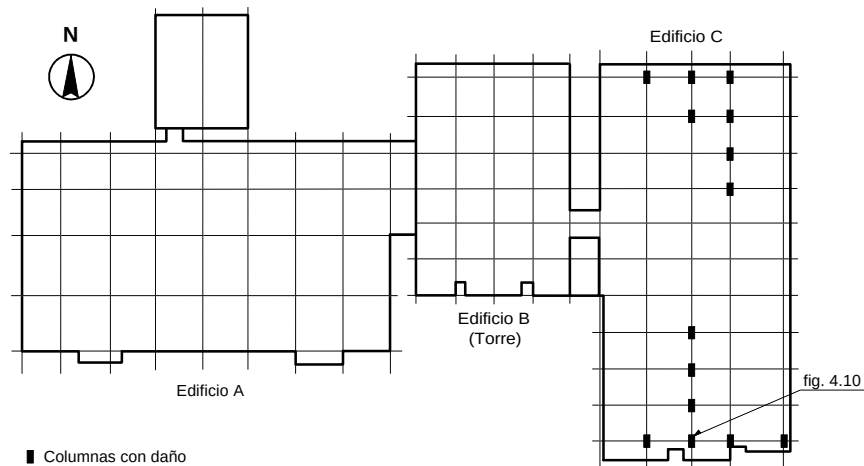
Localización de las columnas con daño por corte en el primer nivel
